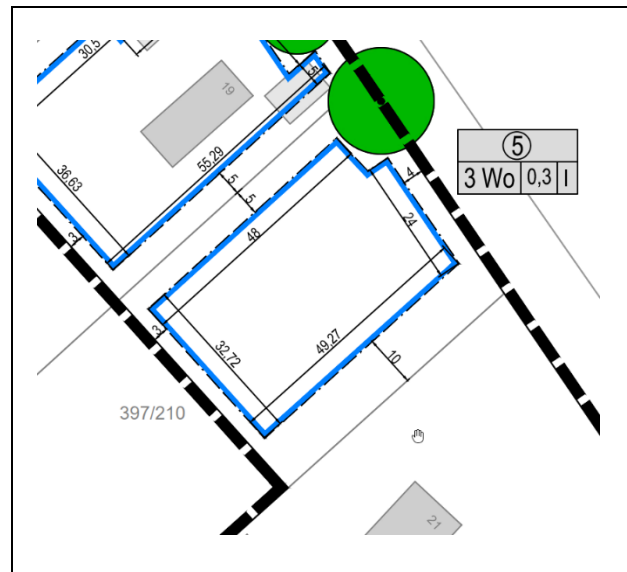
Hausnummer 19a - Lageplan (o.M.)
